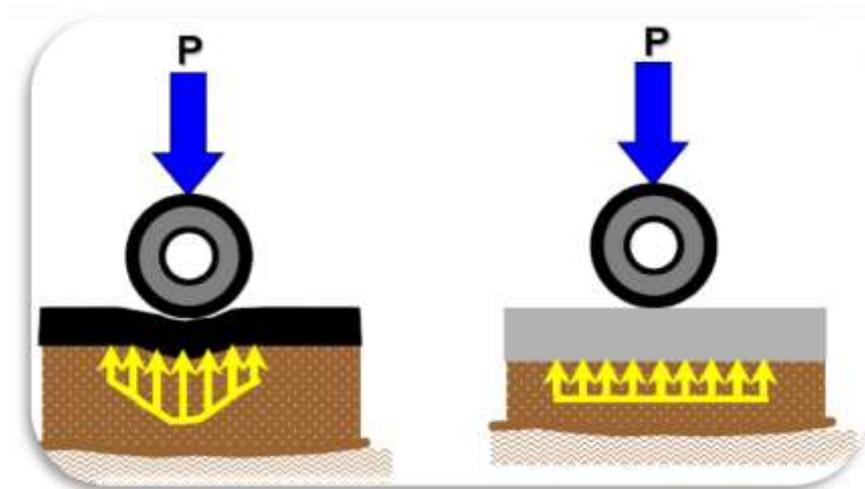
Las presiones en pavimento flexible son mayores a la de los pavimentos rígidos
